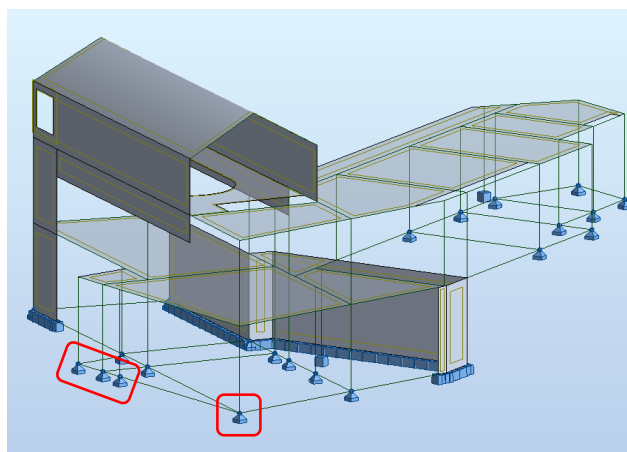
Fundações selecionadas para dimensionamento e pormenorização de armaduras.
